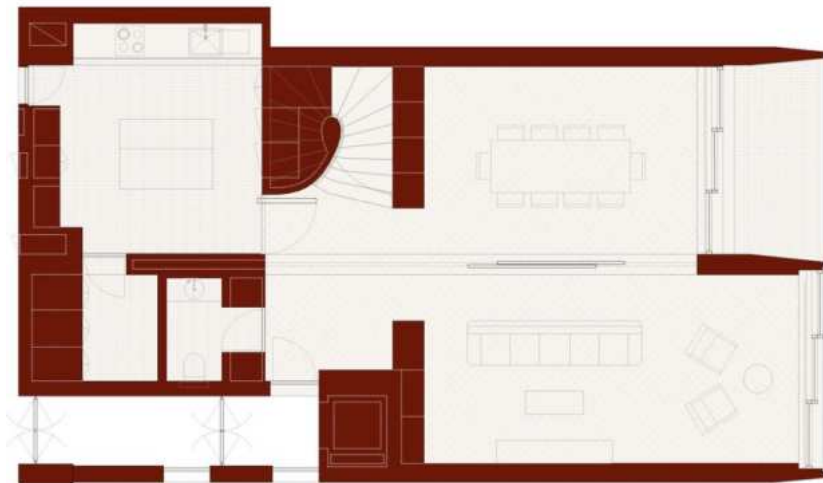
Planta do primeiro piso (ArchDaily, 2008b)
